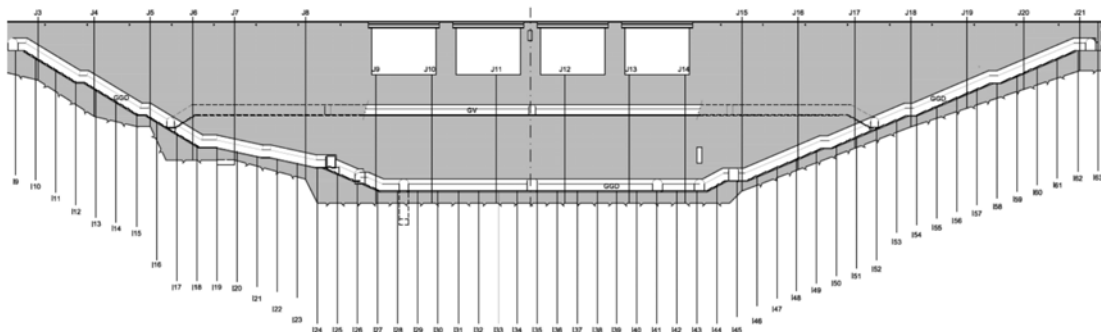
Aspeto geral do projeto da cortina de impermeabilização. Alçado visto de montante para jusante (adaptado de EDP, 2011). (I-furo de impermeabilização; J-junta de bloco; GV-galeria de visita; GGD-galeria geral de drenagem)
